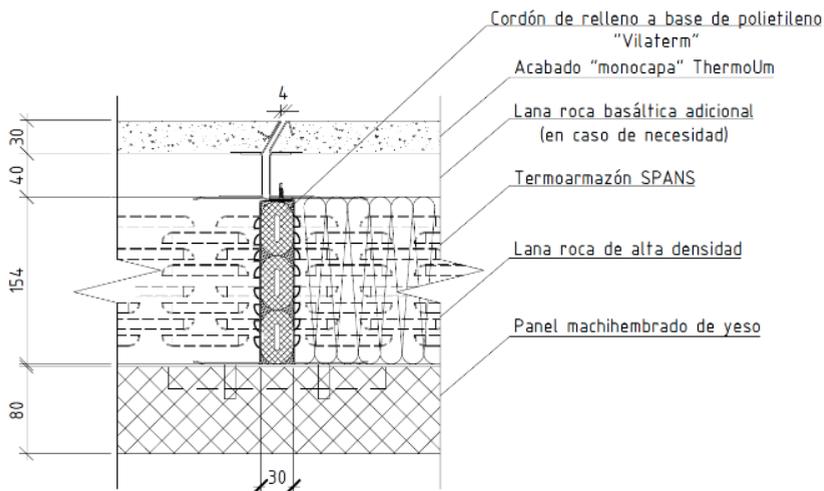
Detalle constructivo de la junta vertical entre dos paneles adyacentes.
